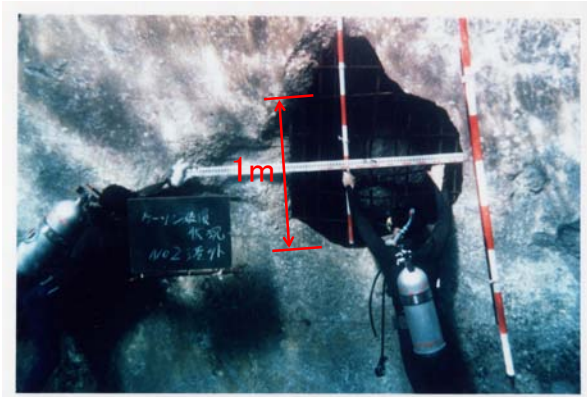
衝撃荷重により局部損傷した防波堤ケーソン壁の例
